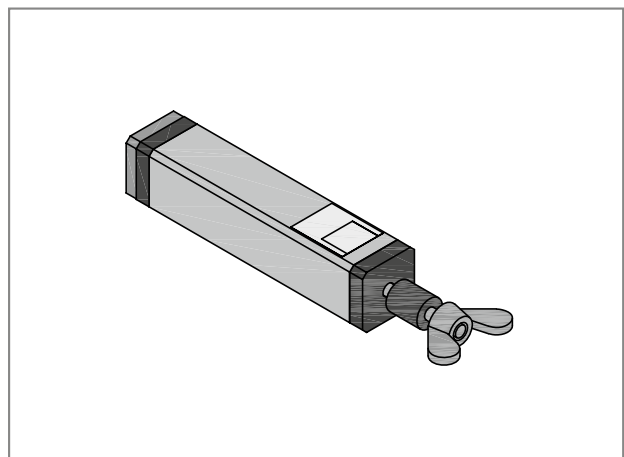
Schöck Tronsole® Typ P: Montageelement
